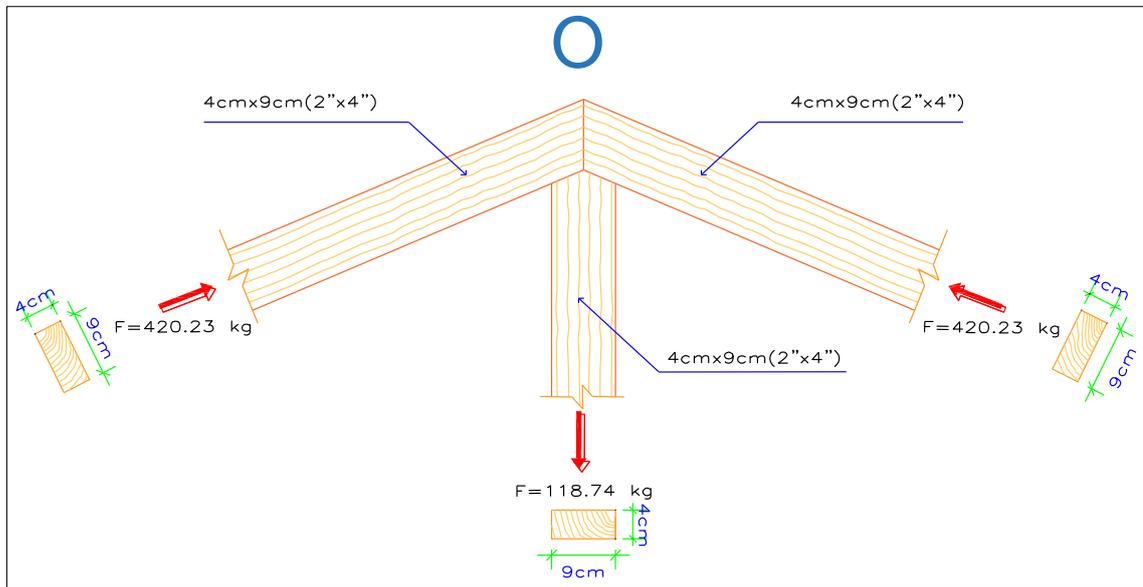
Nudo "O" de la armadura tipo montante maestro
